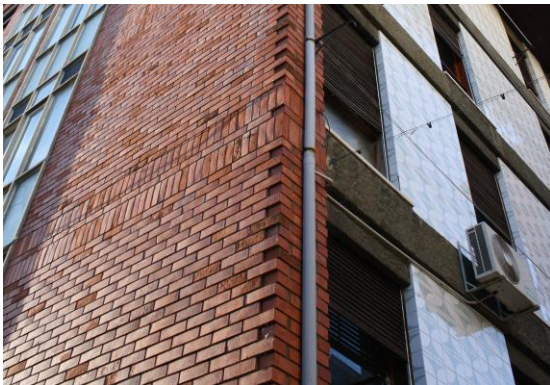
Efeito do aparelho de tijolo do cunhal sudeste, da fachada posterior.
